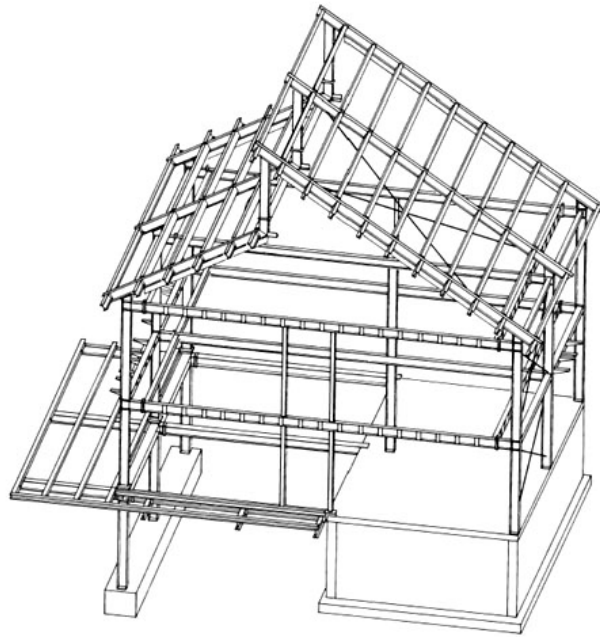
Doppelhaus in Rudolstadt in Skelettbauweise (Rudolstädter Stahlbau GmbH, Rudolstadt) [23]
